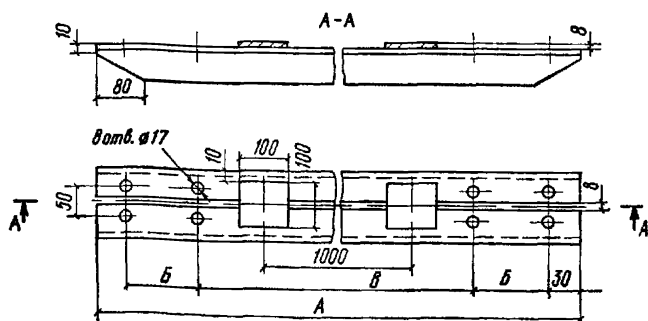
Стяжка из уголков для рельсовых путей с деревянными полушпалами
